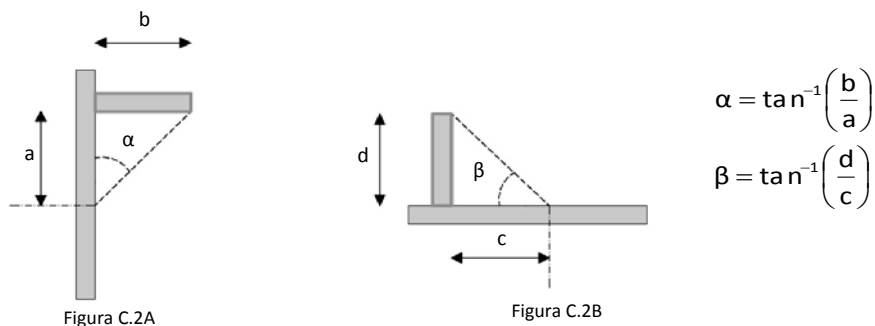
Pareti opache con aggetti orizzontali e verticali (A: sezione verticale; B: sezione orizzontale)
